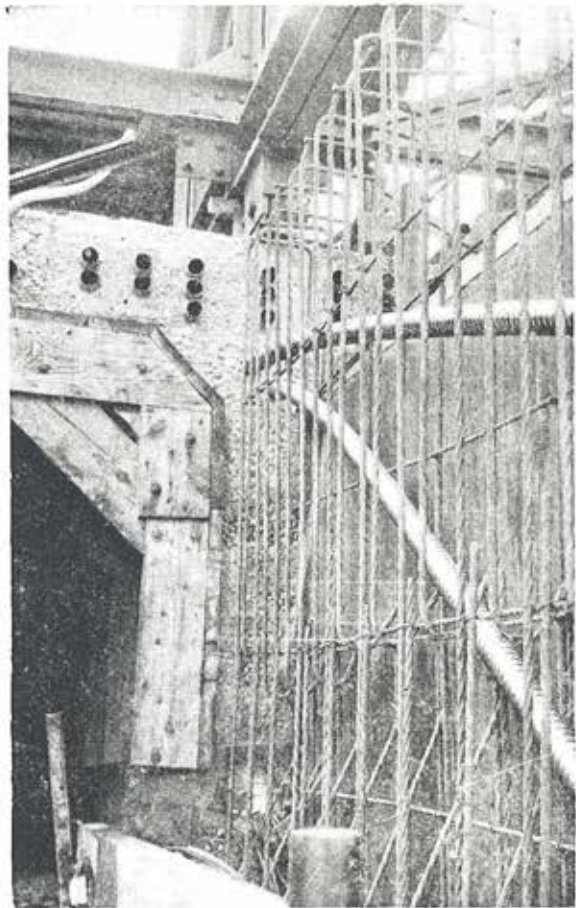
Puente de Lacroix-Falgarde: Detalle de la armadura y el encofrado de una dovela.
